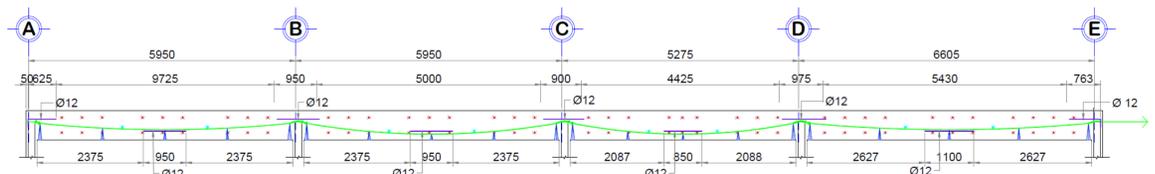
Configuración del tendón en el armado estructural de losa postensada
